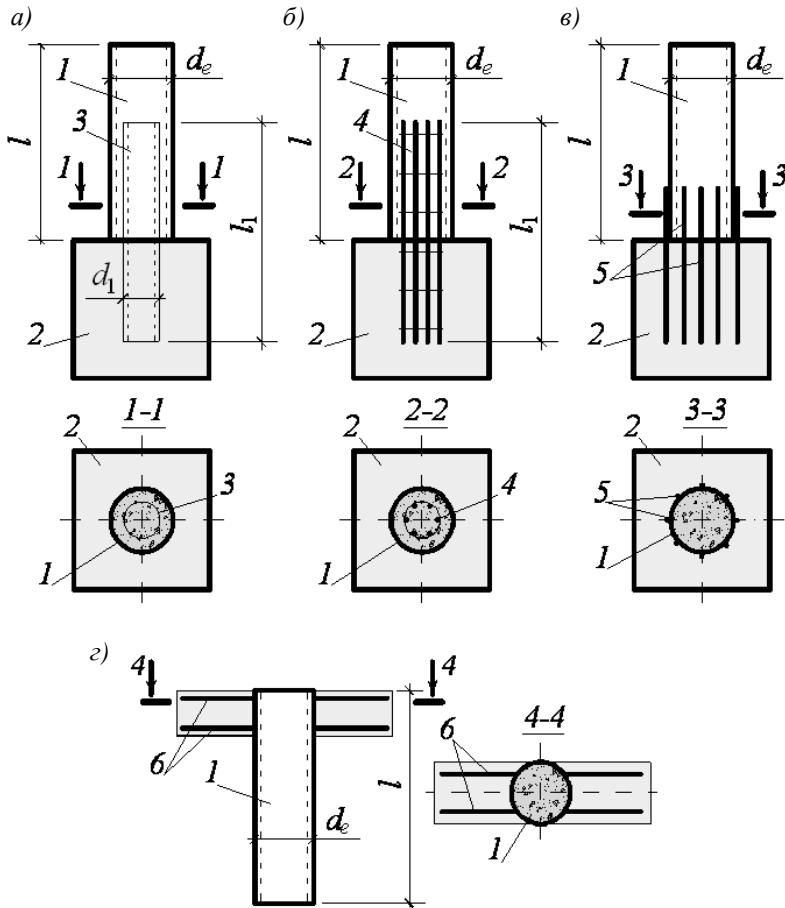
Вузол сполучення трубобетонних елементів з монолітним залізобетonom: 1 – трубобетонний елемент; 2 – залізобетонний елемент; 3 – з'єднувальний трубчастий стрижень; 4 – з'єднувальний арматурний каркас; 5 – анкерні арматурні стрижні; 6 – арматурні вути
